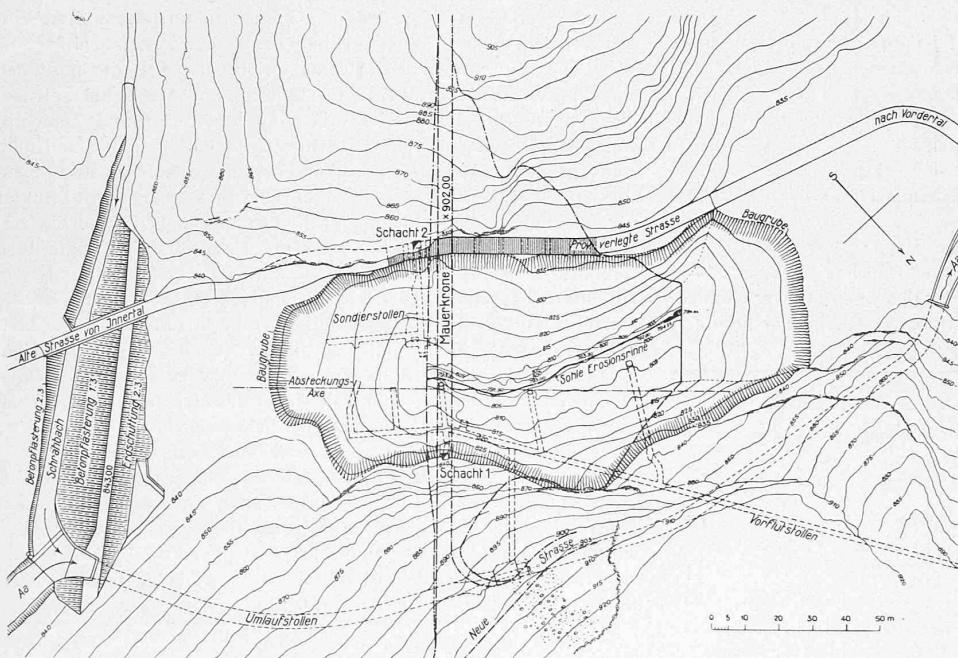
Lageplan der Baugrube für die Staumauer im Schräh. — Maßstab 1:2000.
